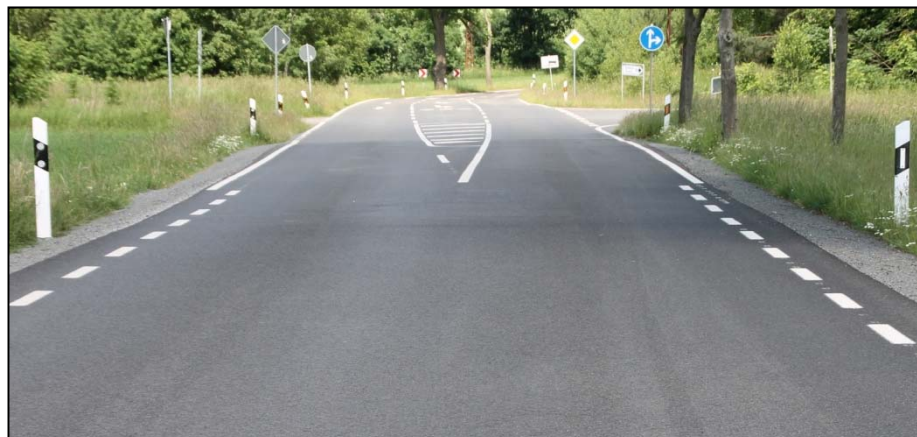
Übergangsbereich der S 20 am plangleichen Knotenpunkt
